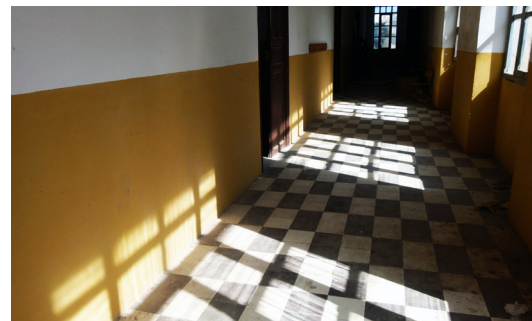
, Zócalo de pintura color ocre en pasillo de planta alta
